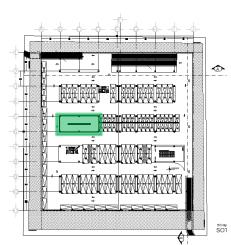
Ubicación en el plano de planta de tratamiento de aguas residuales.
